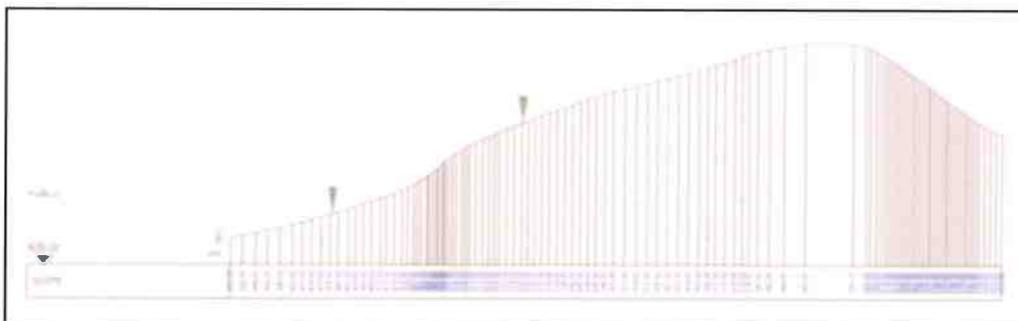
Profilo altimetrico SdF sezione 2 (da elaborato n. 3)
